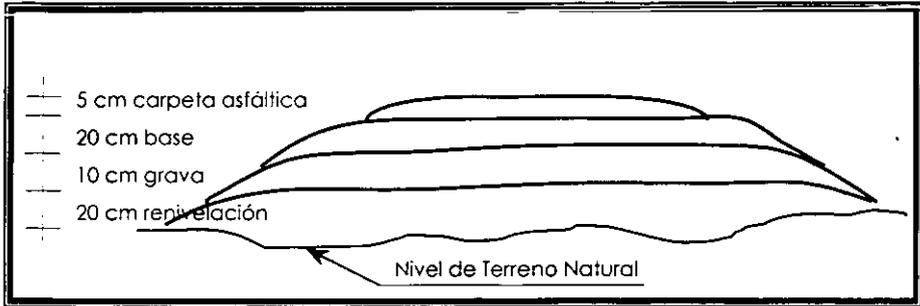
Estructura de pavimento en las vialidades alternas a la obra.
